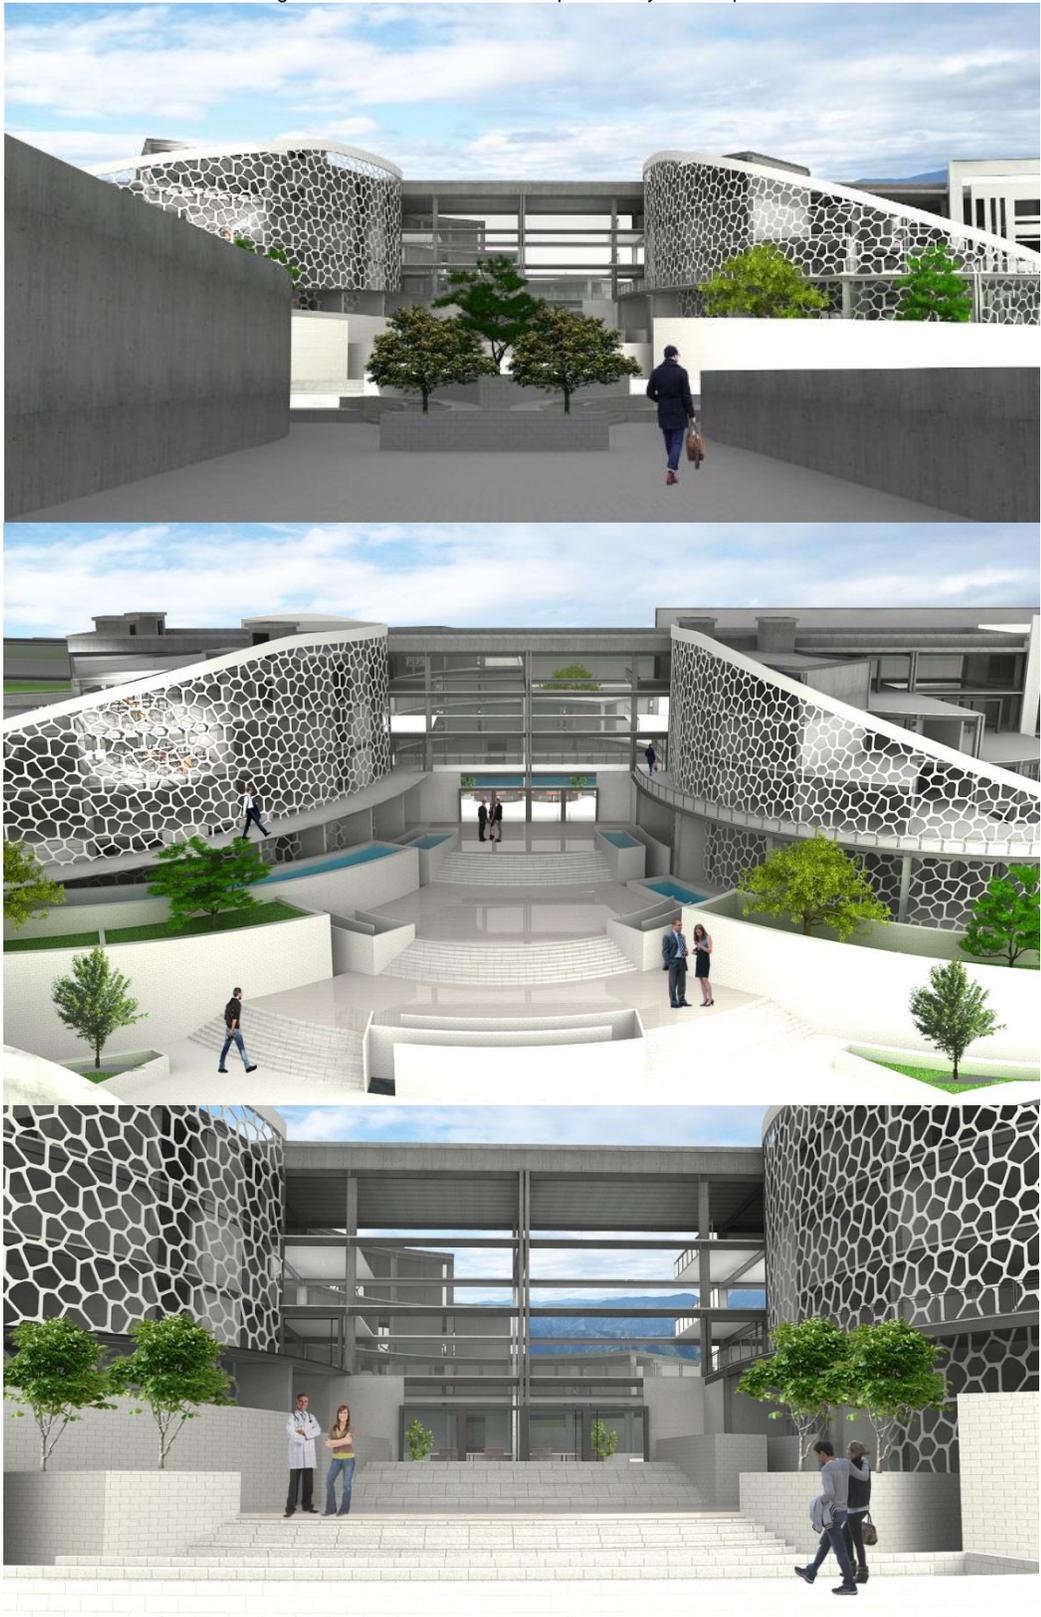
Render Acceso Principal al Proyecto Arquitectónico.
